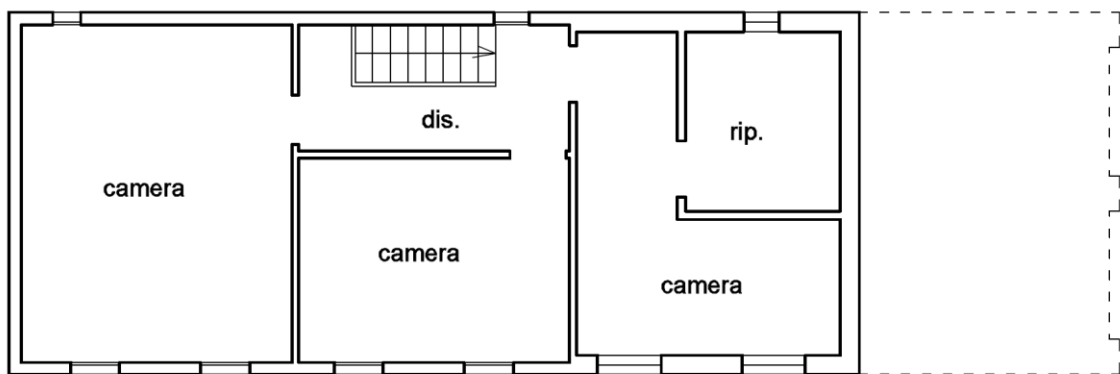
schema a vista (fuori scala) dell'abitazione oggetto di esecuzione
